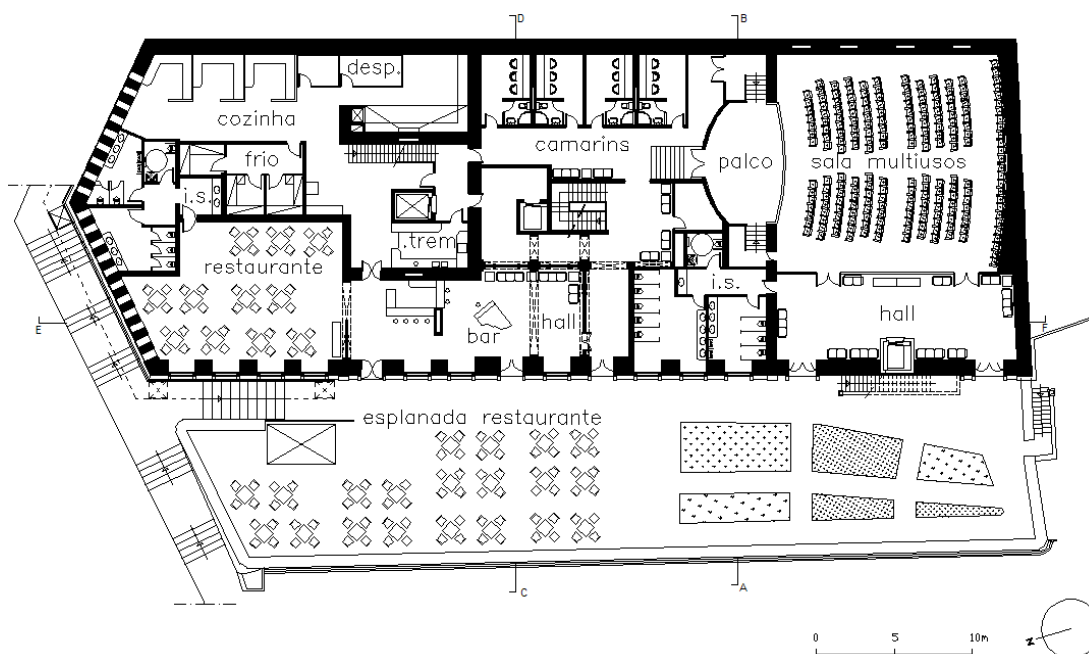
Planta do piso -1 (Palácio da Quinta da Graça).
